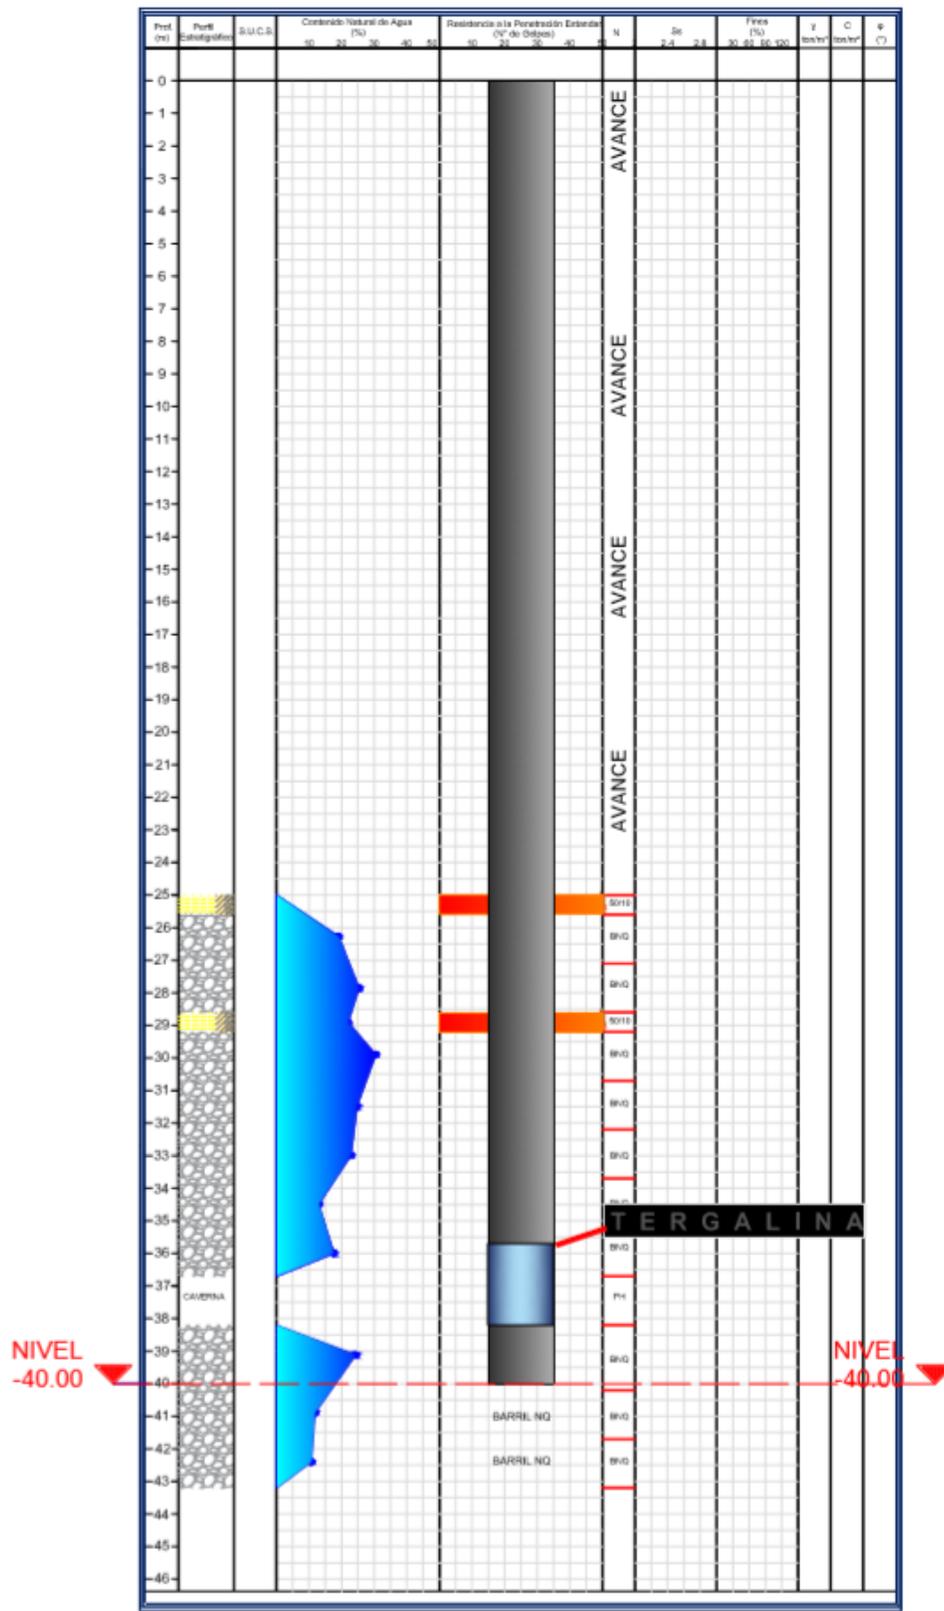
DESPLANTE DE PILA 21 (SM-13-EJE H5).
